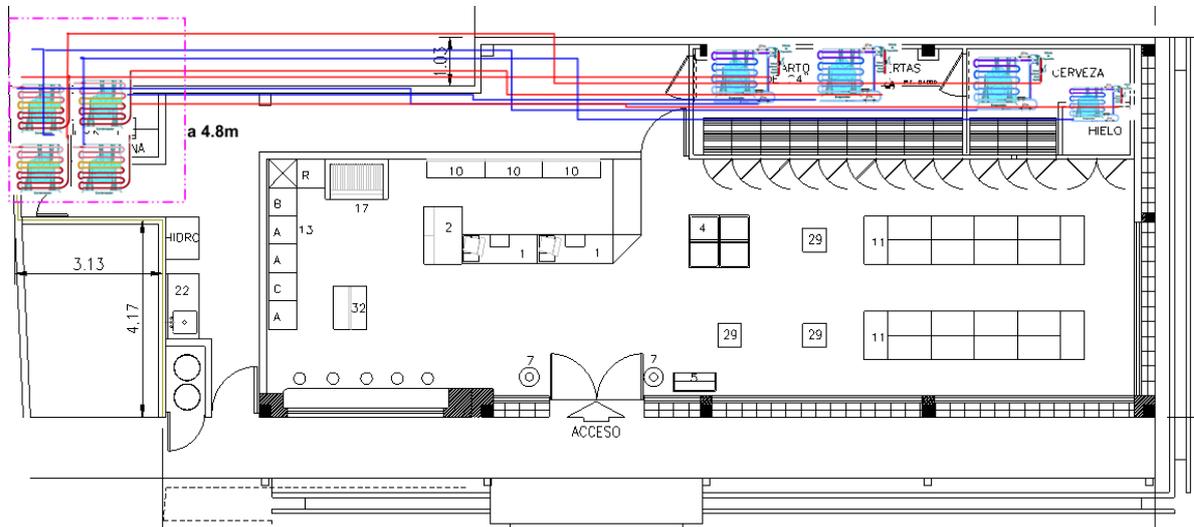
Layout de Tienda y sistema de refrigeración SKY
